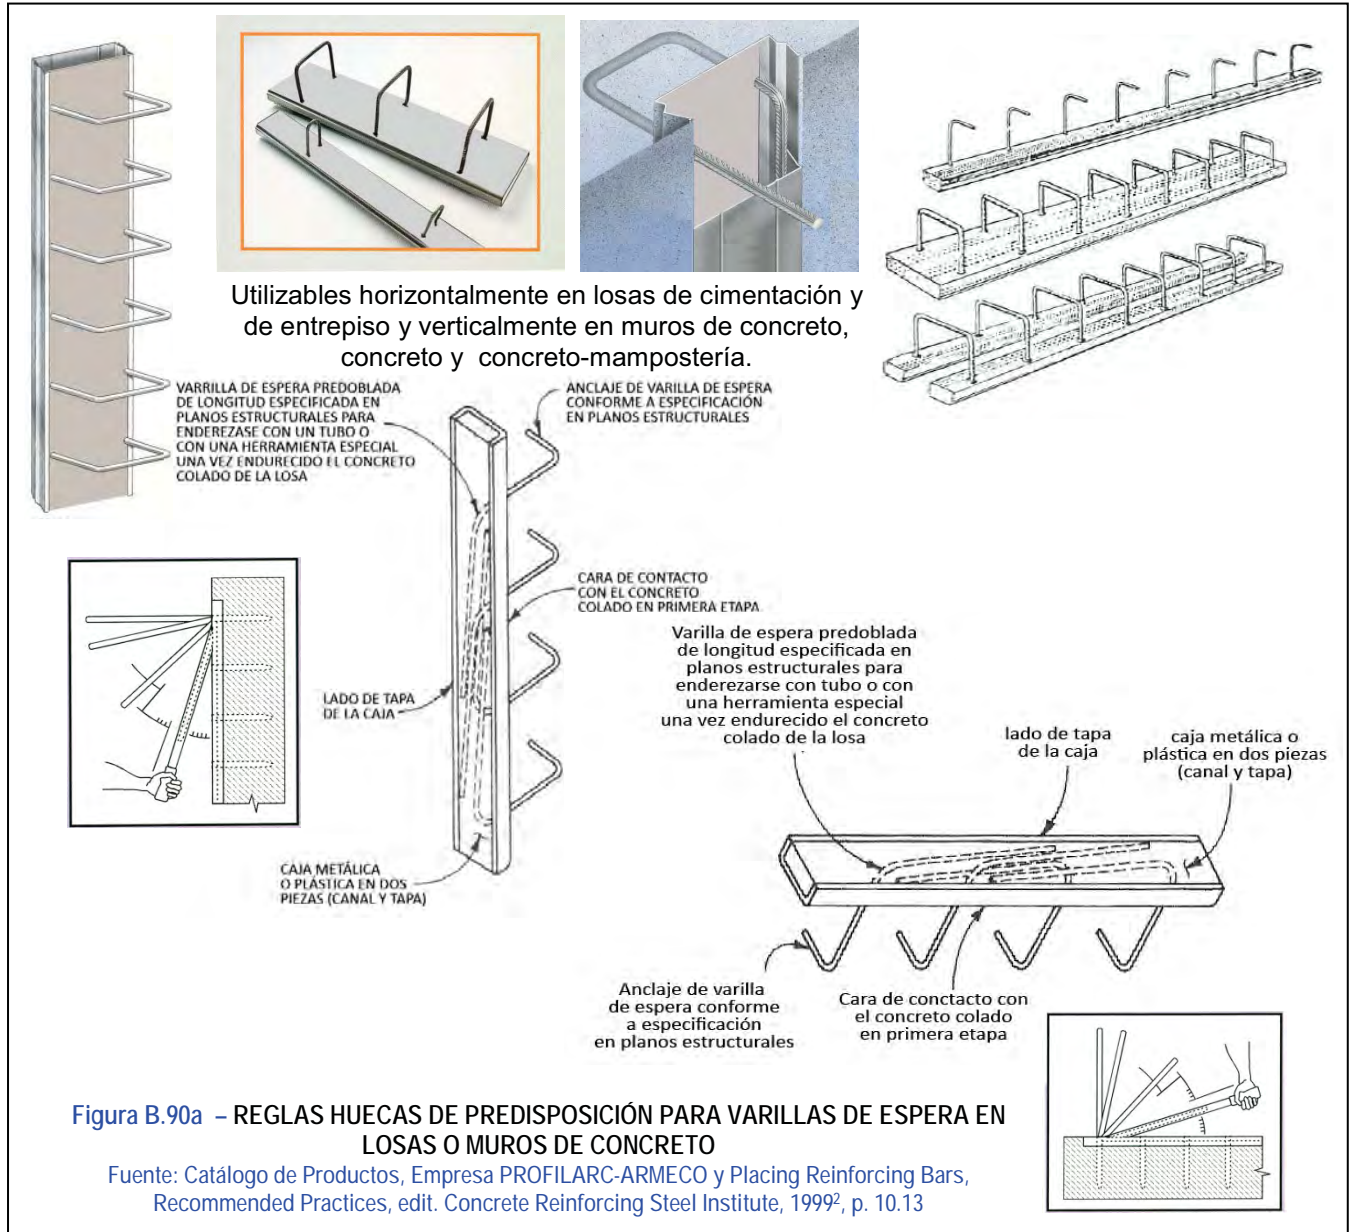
REGLAS HUECAS DE PREDISPOSICIÓN PARA VARILLAS DE ESPERA EN LOSAS O MUROS DE CONCRETO
